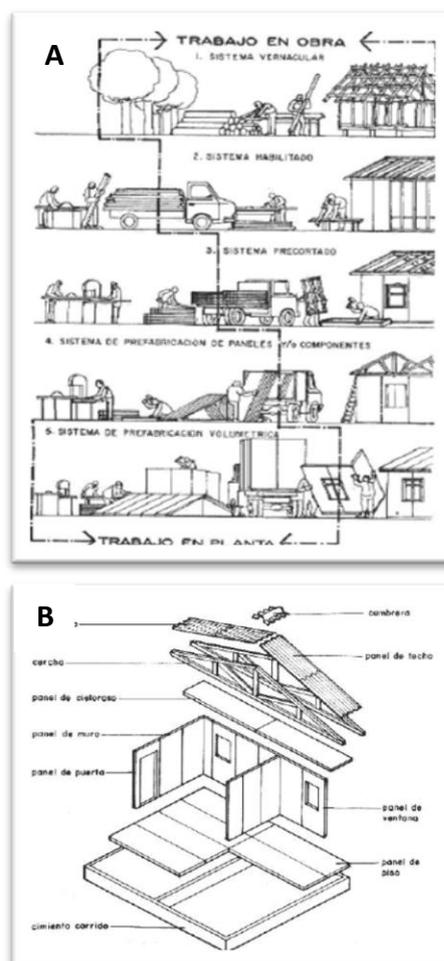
A) Tipos de sistemas constructivos con madera, B) sistema de prefabricación con tableros. Fuente: PADT – REFORT 1984
